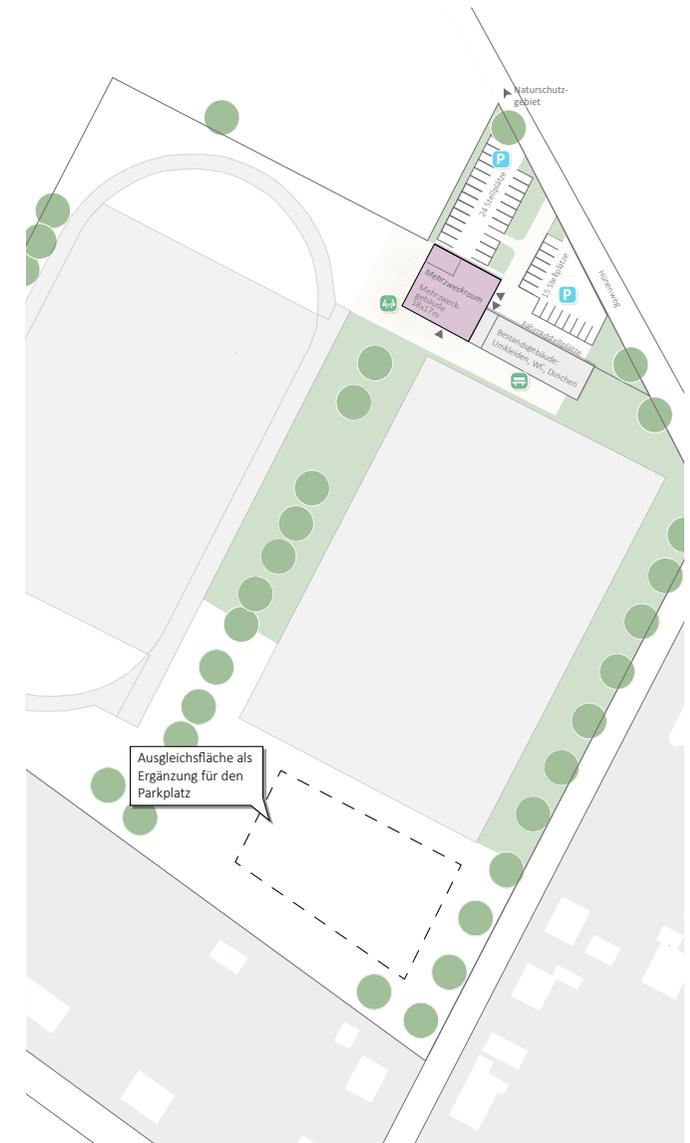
Parkraumergänzung auf Ausgleichsfläche
